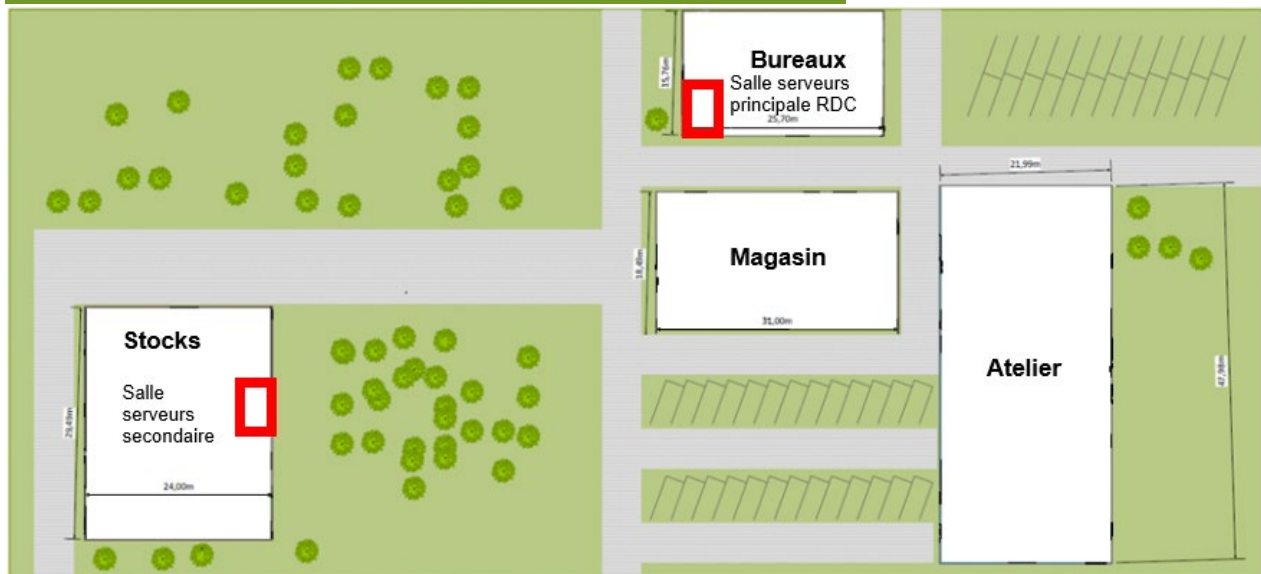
Plan d'implantation des serveurs à Dax 1/2
